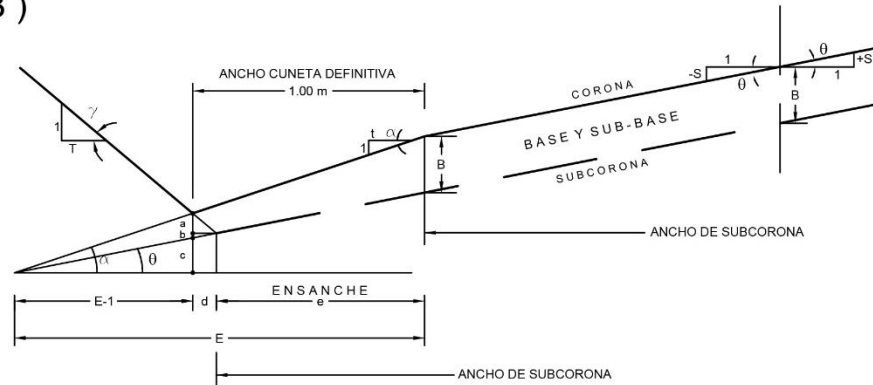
Ensanche de la sub corona para alojar cunetas
